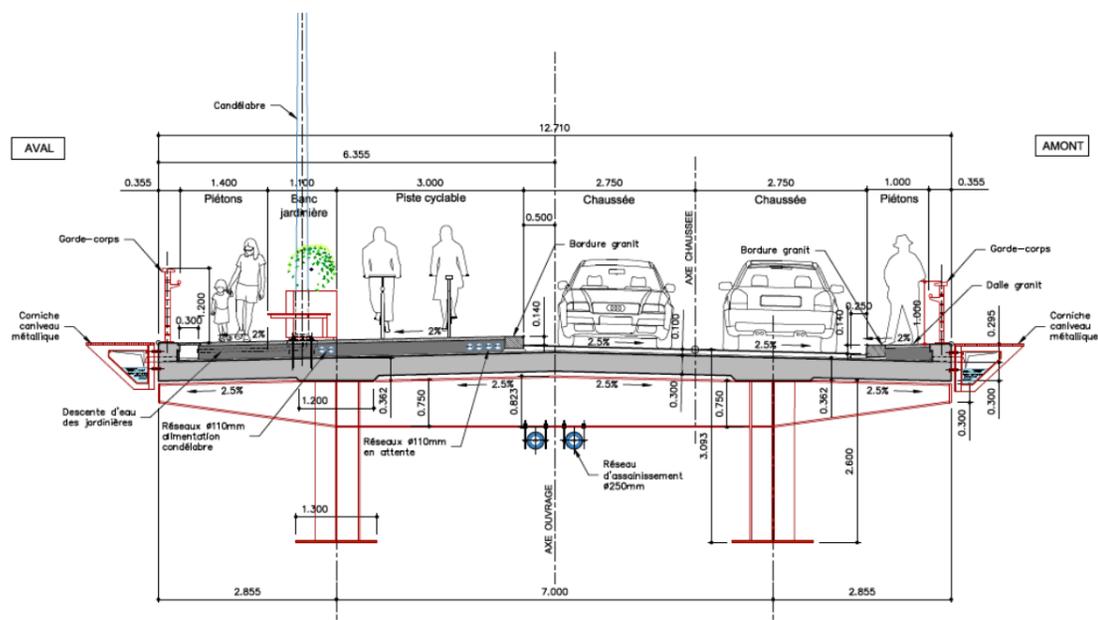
Profil en travers de l'ouvrage – Extrait Mémoire technique (Ingérop)
